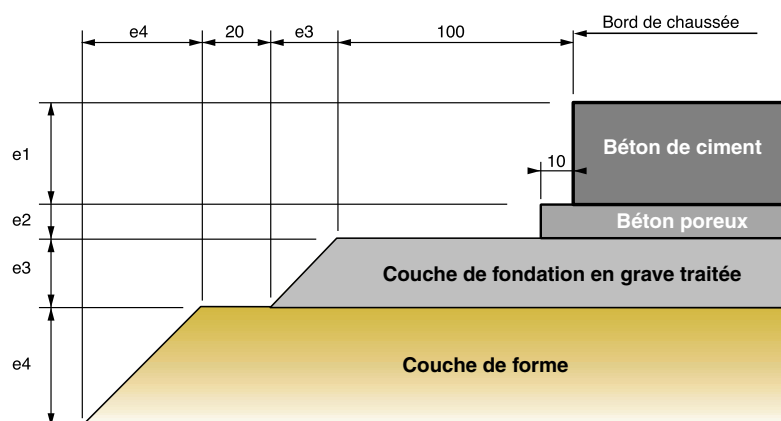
Surlargeurs des différentes couches de chaussées (béton poreux)
